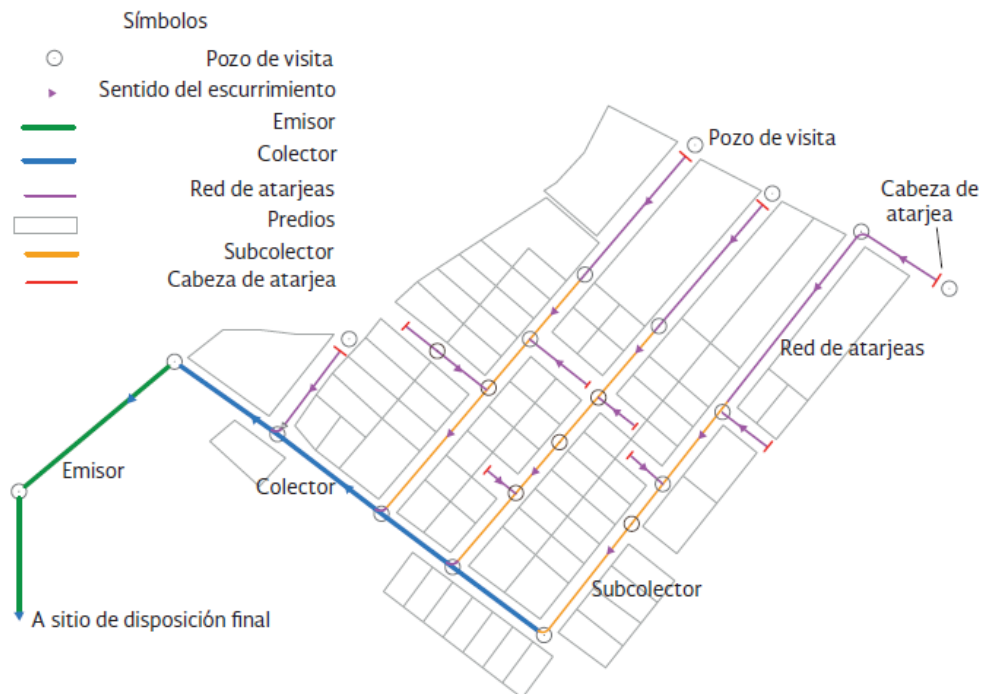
Estructuras de conducción en una red de drenaje. Fuente: CONAGUA, 2015.
